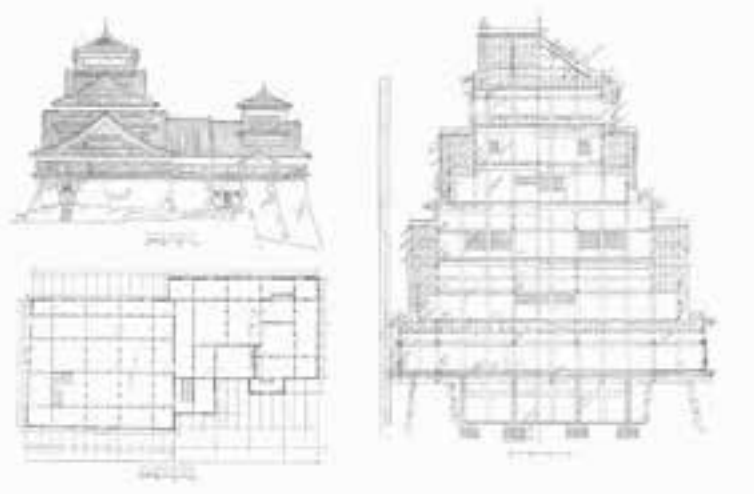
坂本新八「熊本城復興設計図」より天守東立面図・1階平面図・断面図
